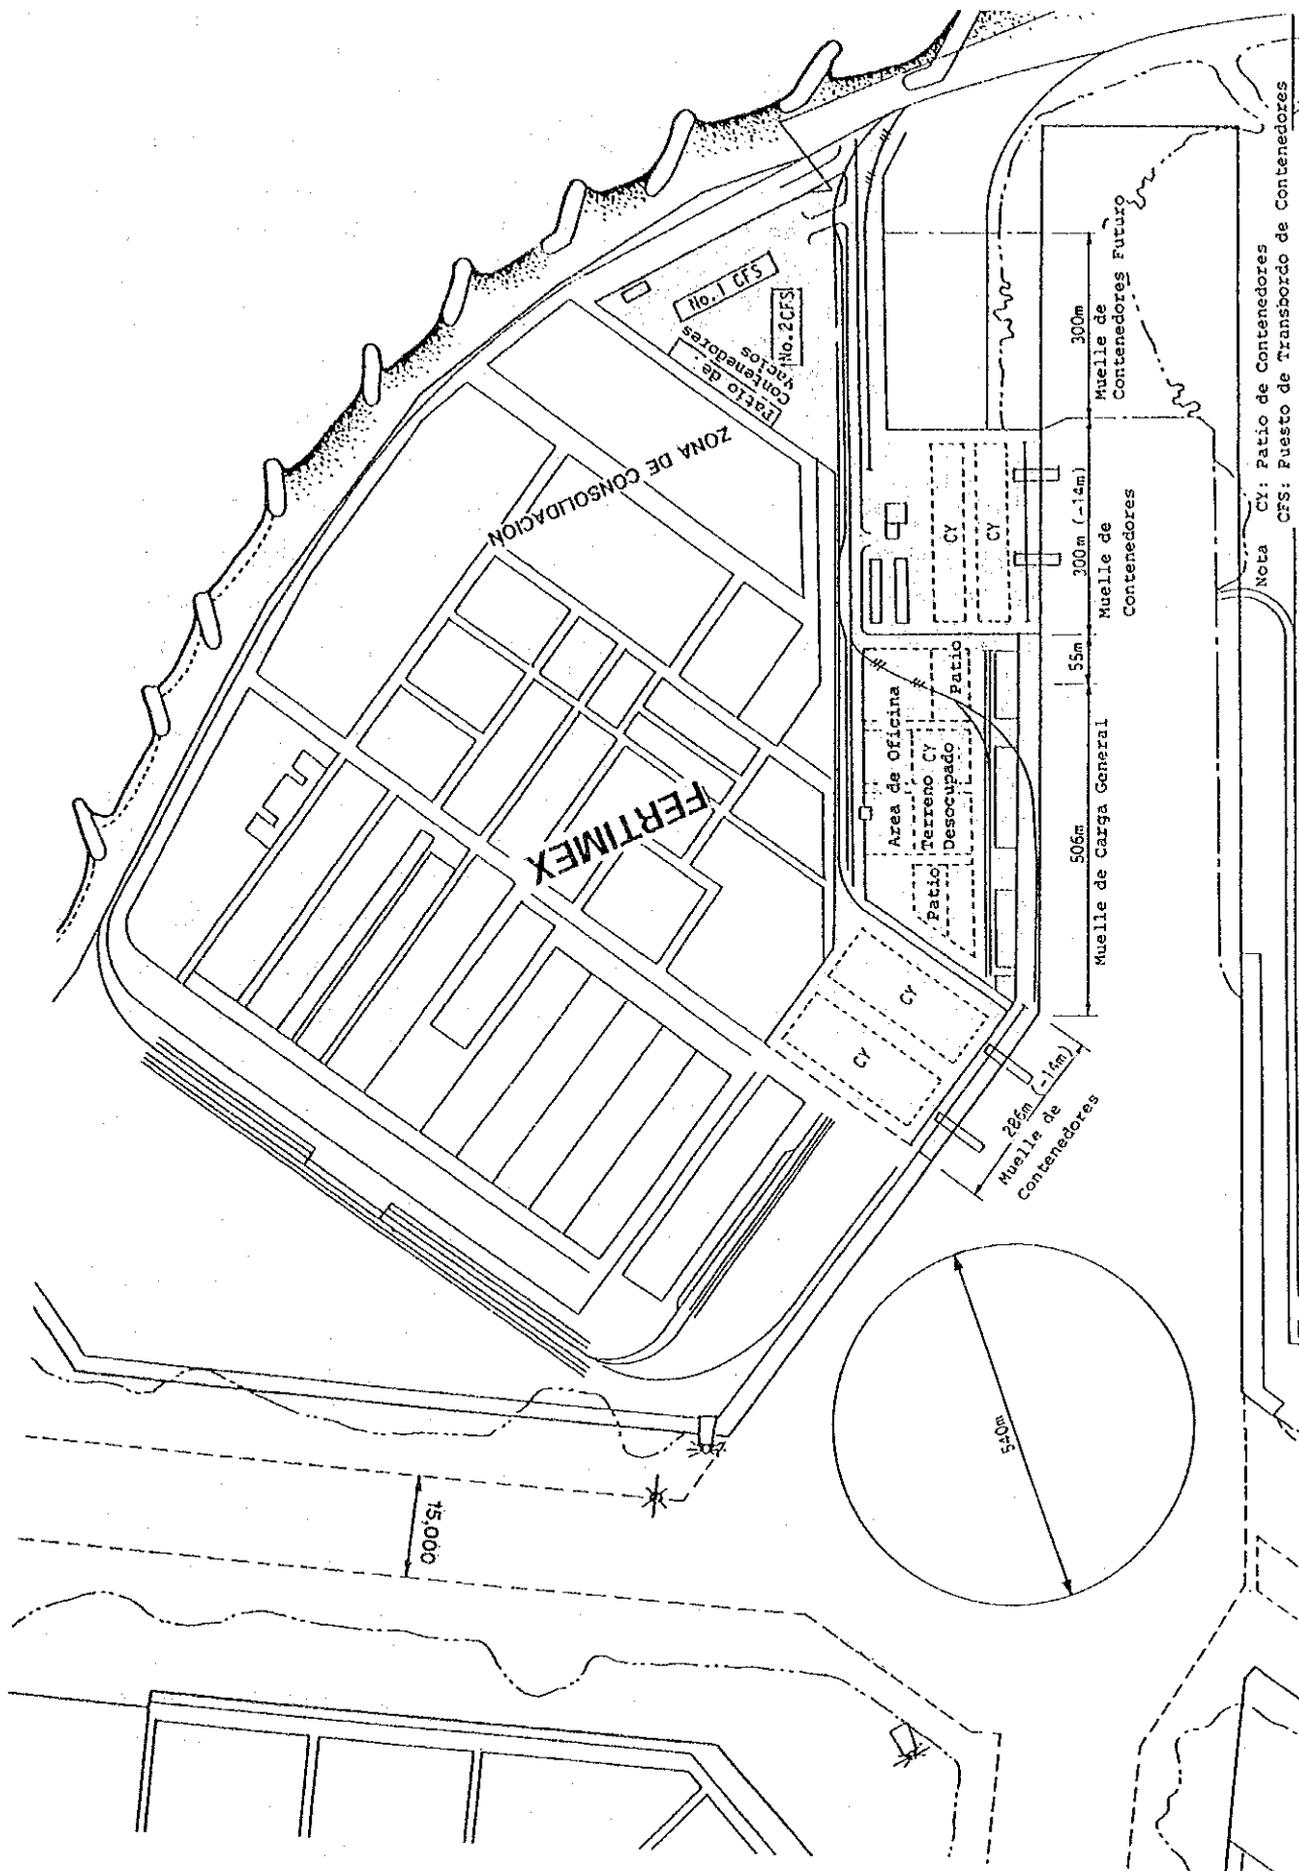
Plan de Disposición General para Carga Contenerizada (Puerto de Lázaro Cárdenas: 2005)
